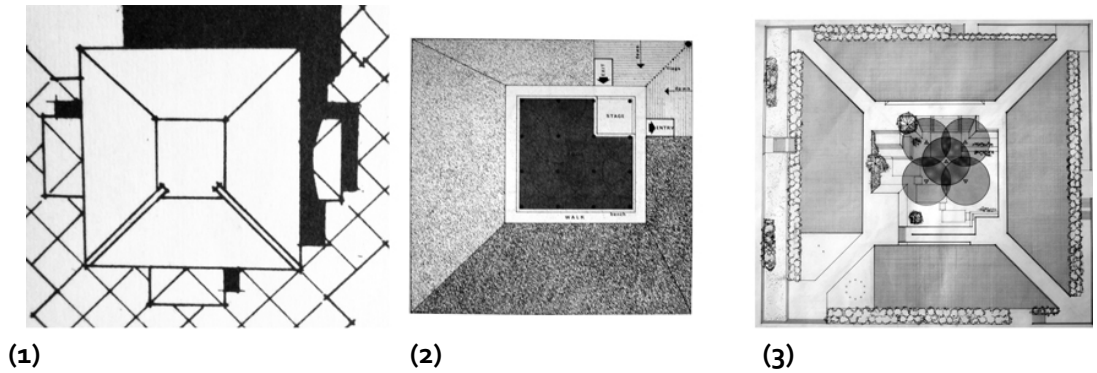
Comparatif du plan d'implantation de trois pavillons par Arthur Erickson et Geoffrey Massey : (1) pavillon canadien à l'Expo Montréal 1967, (2) pavillon non construit pour la Colombie-Britannique à l'Expo Osaka 1970, (3) pavillon canadien à l'Expo Osaka 1970. Source : (1) Institut royal d'architecture du Canada, Introduction d'un concept urbain dans la planification de l'exposition Expo 67, Montréal, s.n., 1965; (2) Portfolio du projet (sans titre), fonds d'archives Arthur Erickson, CCA; (3) Plan à la deuxième étape du concours, Fonds d'Archives Erickson, CAA.
